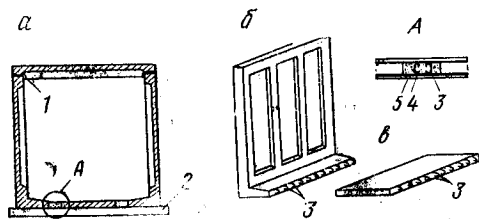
Односекционный тоннель с угловыми стеновыми элементами и плитами покрытия и днища
